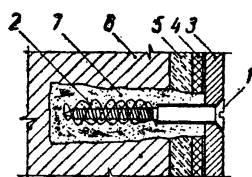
Dibuș din spirală de sîrmă zincată :
